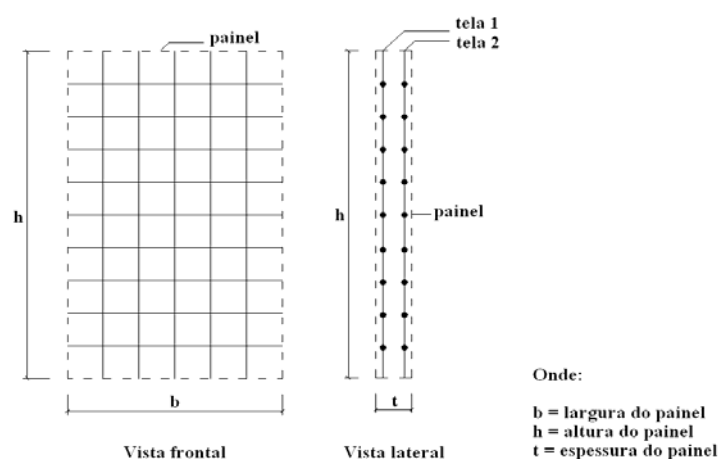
Disposição de telas soldadas Q196 nos painéis
